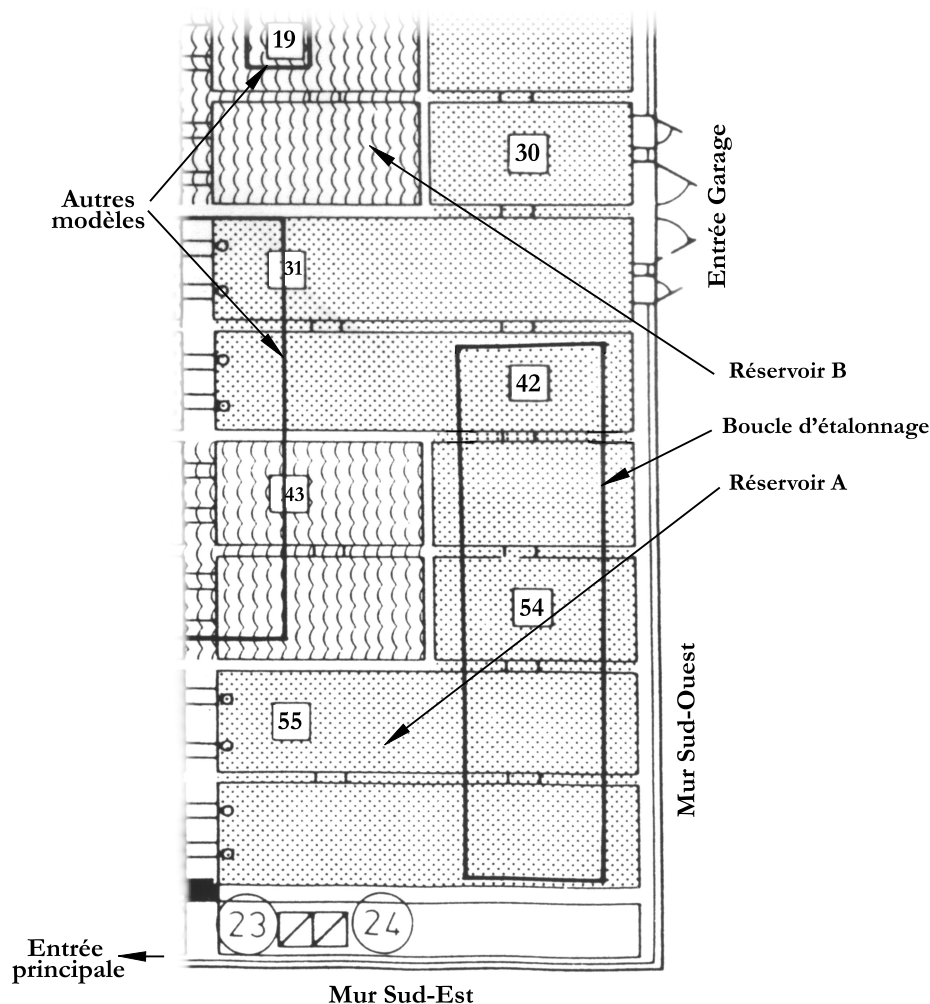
Extrait du plan général des réservoirs du hall d'essai avec la position actuelle des modèles
